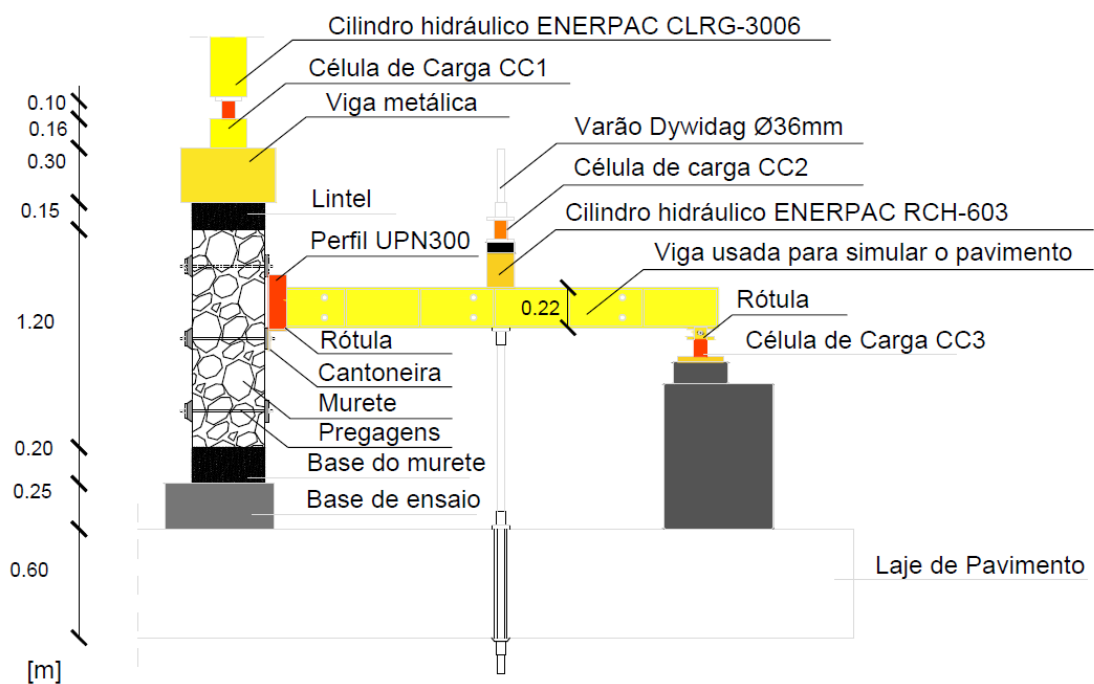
Vista em corte do ensaio de ligação parede-pavimento
